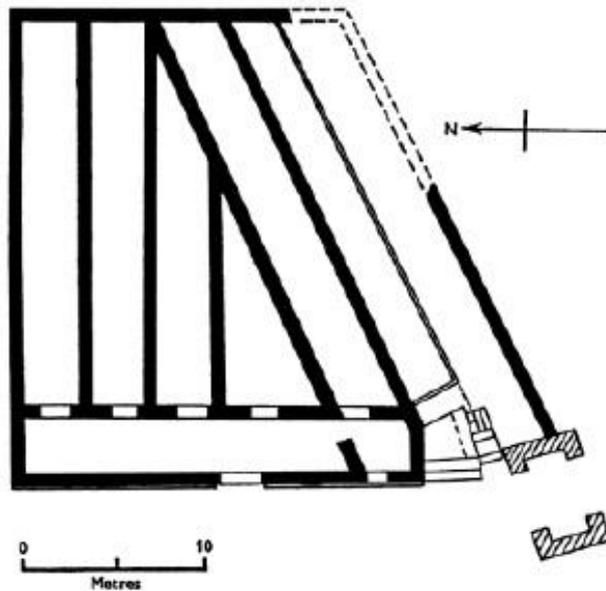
Planta dos celeiros de Cuicul, retirada do livro *Roman Graniers and Store Buildings*, de Geoffrey Rickman
